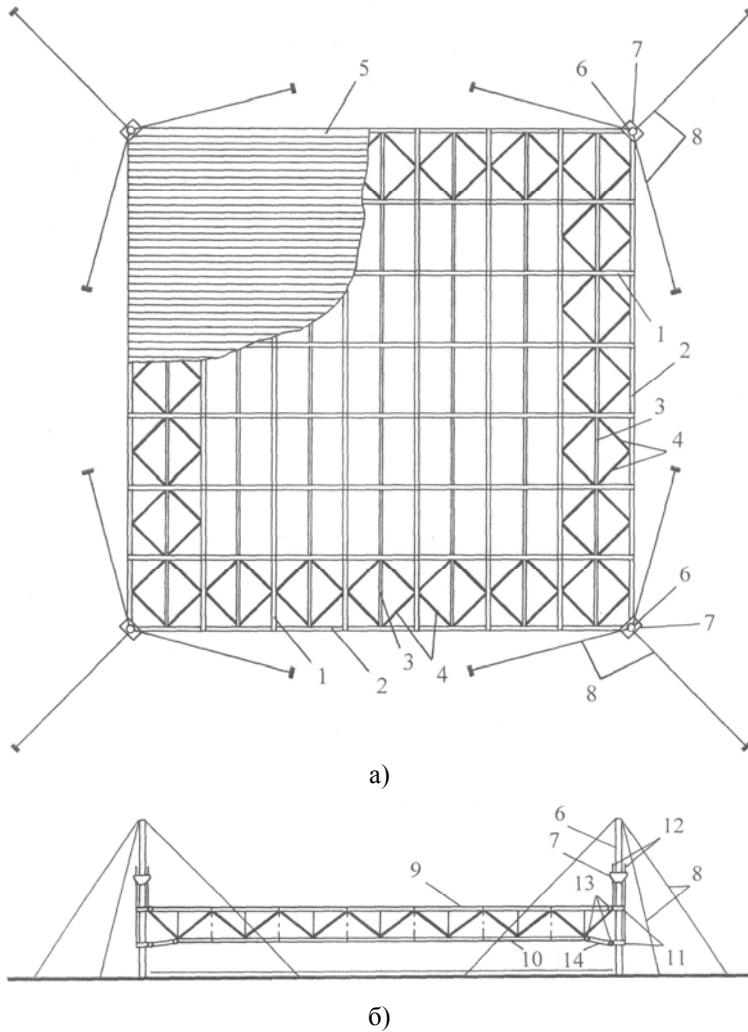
Схемы пространственного покрытия из перекрестной системы в процессе монтажа по методу подъема: а – вид сверху; б – вид сбоку в начальной стадии подъема; 1 – внутренние фермы; 2 – контурные фермы; 3 – прогоны; 4 – приконтурные связи по нижним поясам ферм; 5 – профилированный настил; 6 – угловые колонны; 7 – подъемники; 8 – расчалки; 9 – верхний пояс контурных ферм; 10 – нижний пояс контурных ферм; 11 – парные обоймы; 12 – грузовые туги; 13 – шарниры; 14 – стержневые элементы с парными реверсивными устройствами
